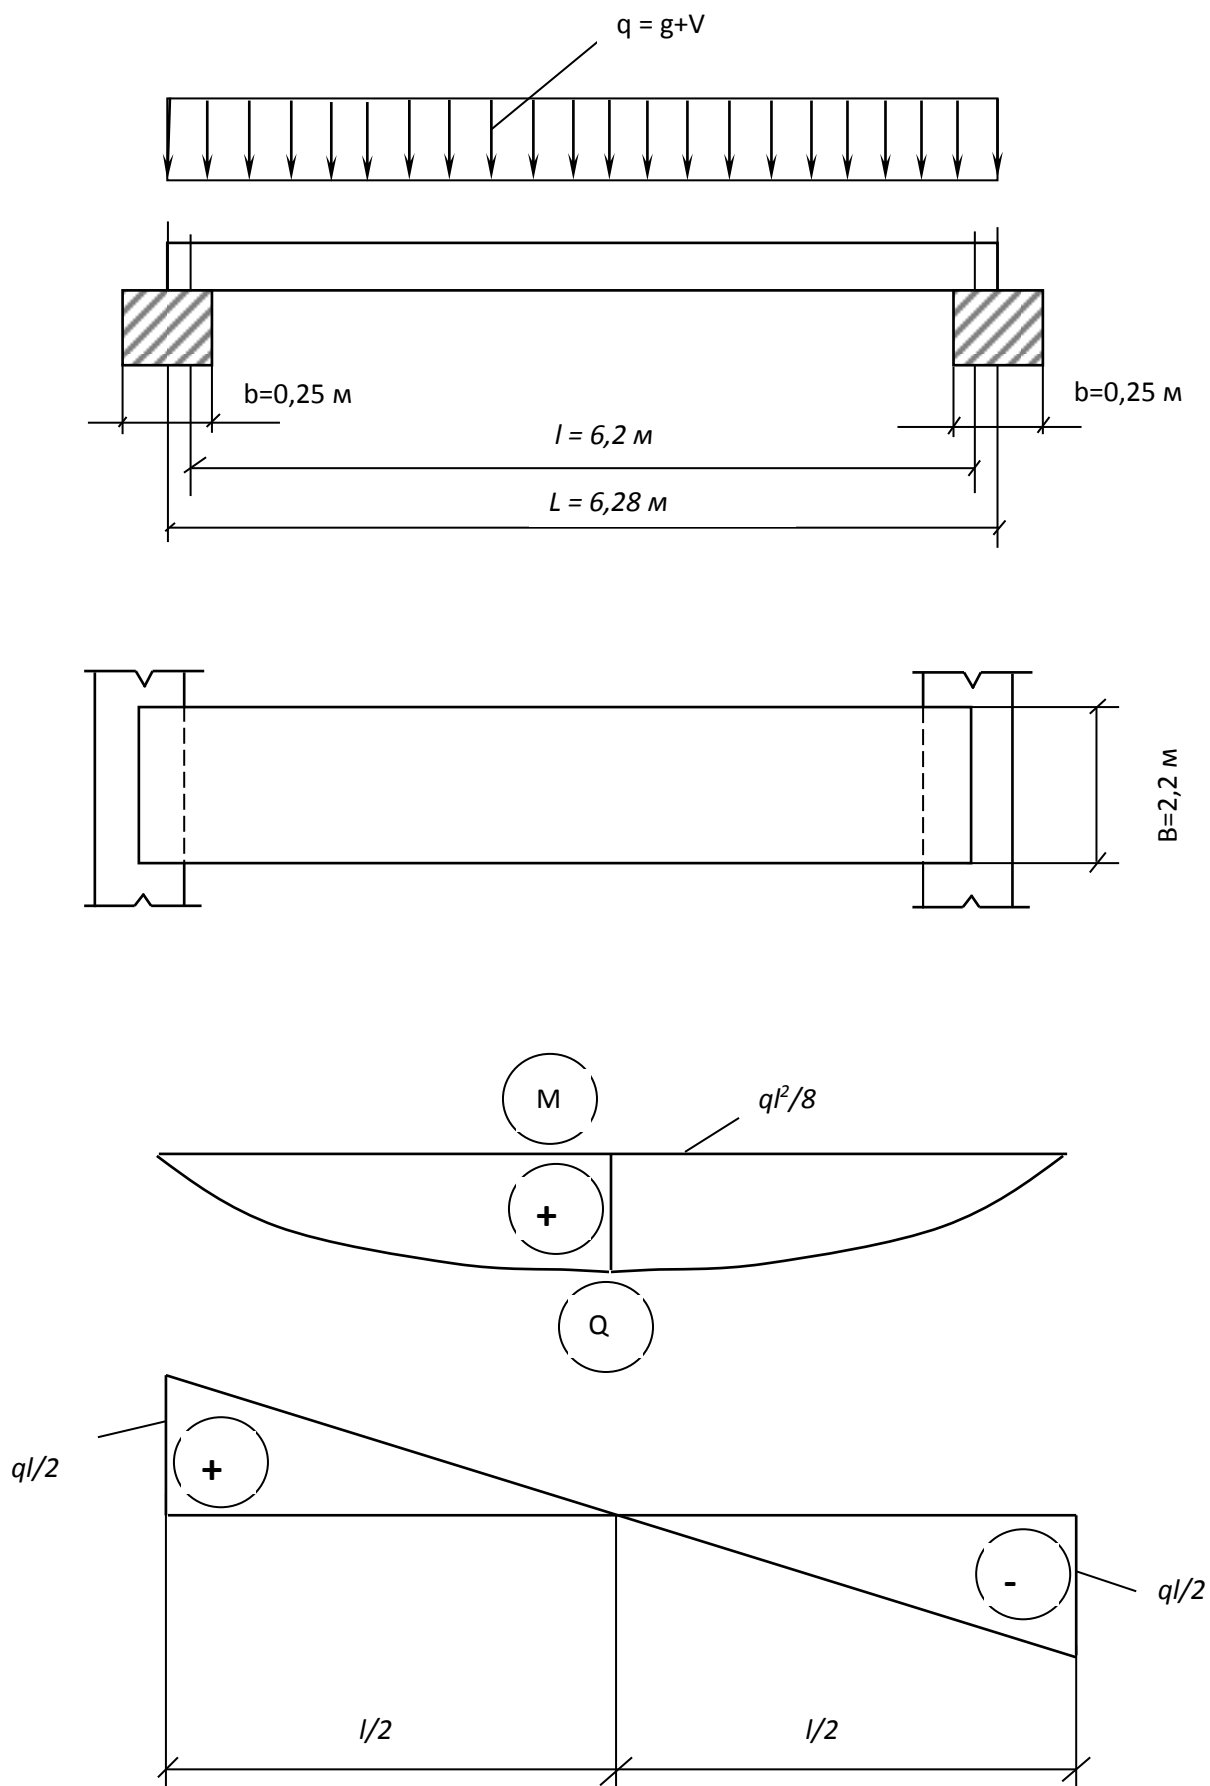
Расчетная схема плиты и эпюры расчетных усилий (изгибающих моментов M и поперечных сил Q)
